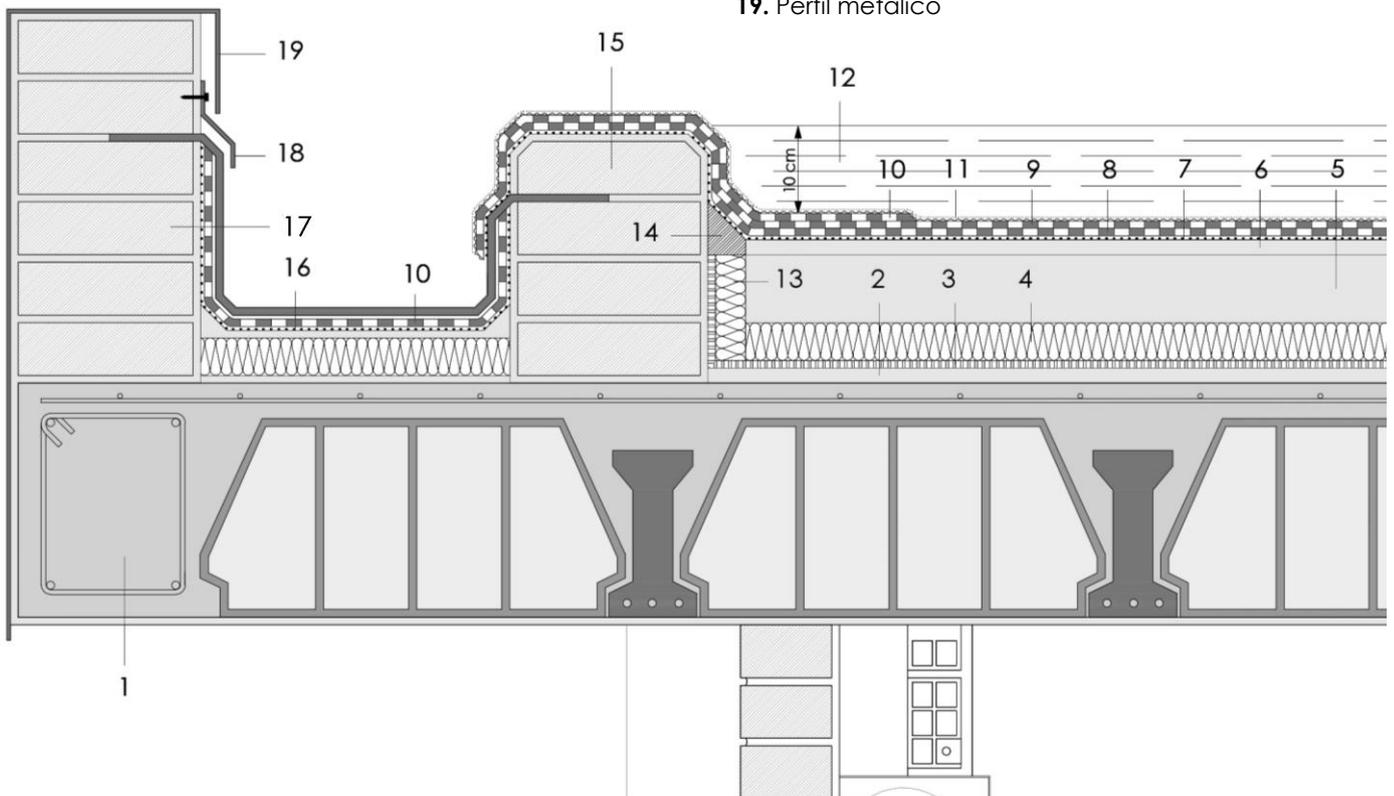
Sección constructiva del peto perimetral exterior. Rebosadero. E: 1/10
